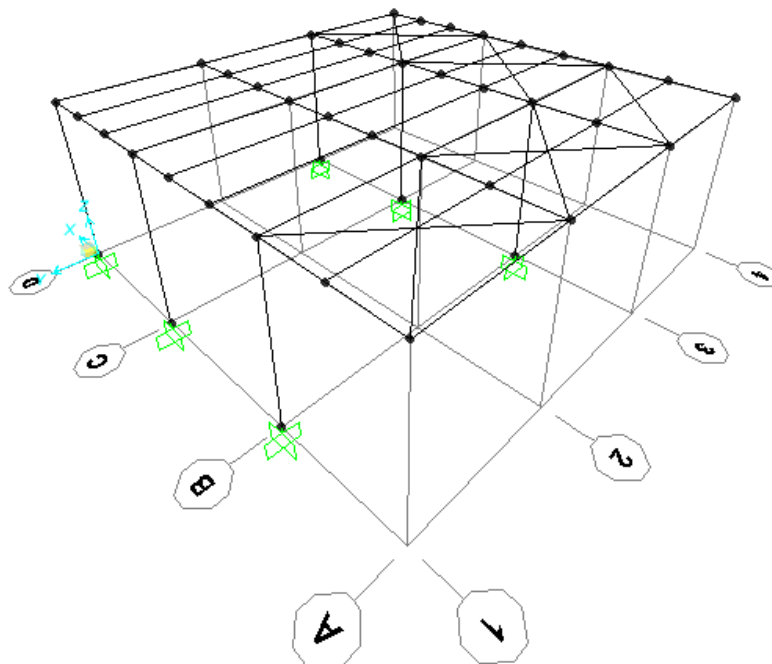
Vista assonometrica modello struttura in elevazione
